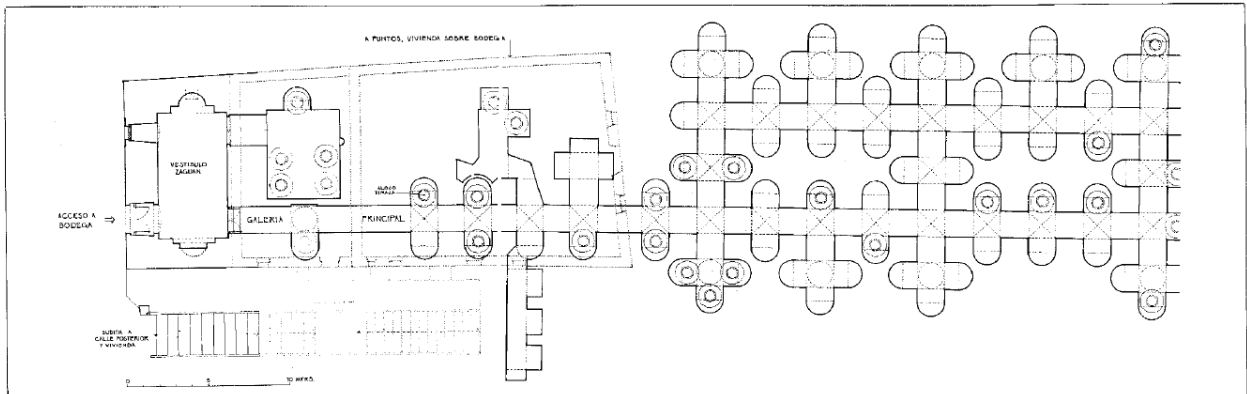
Planta, levantamiento. Fuente: Sandoval, J. (1991).
